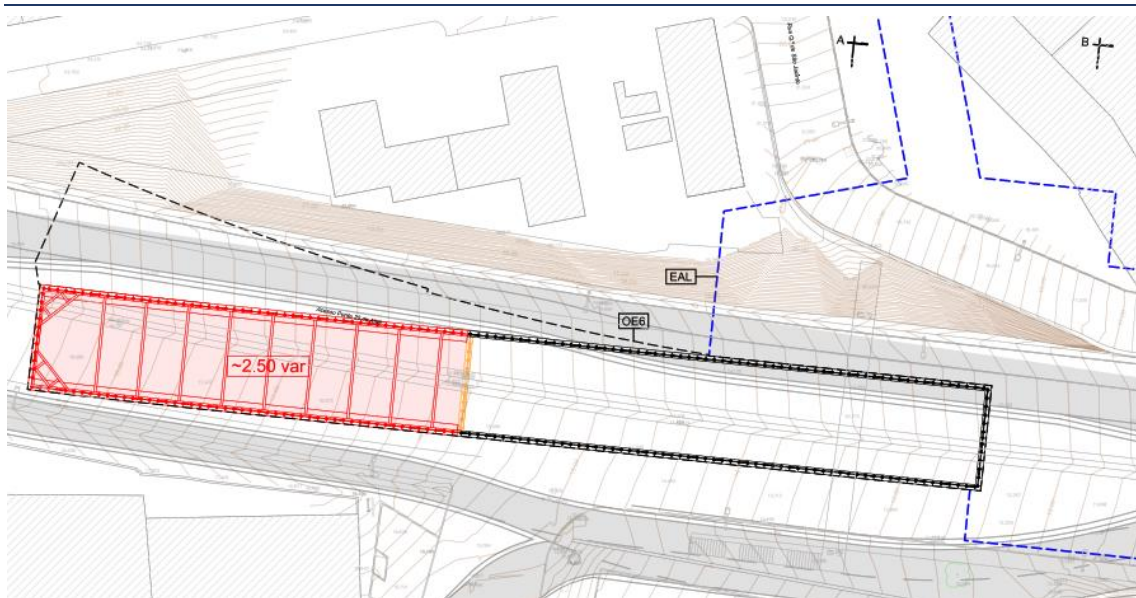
Planta de Dimensionamento Contenção Provisória – 2ª Fase de escavação
